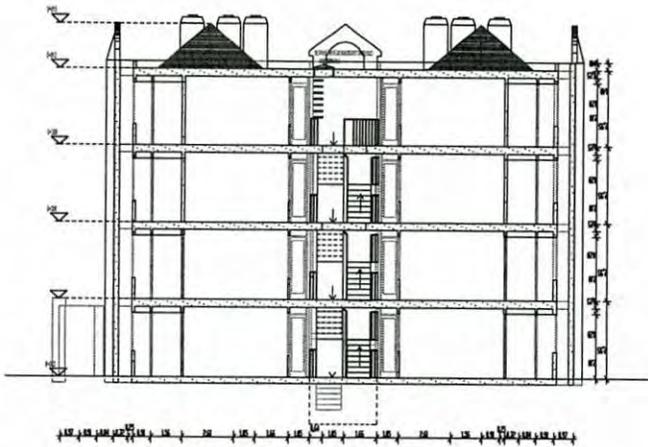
Plano de la fachada trasera, y alturas.
